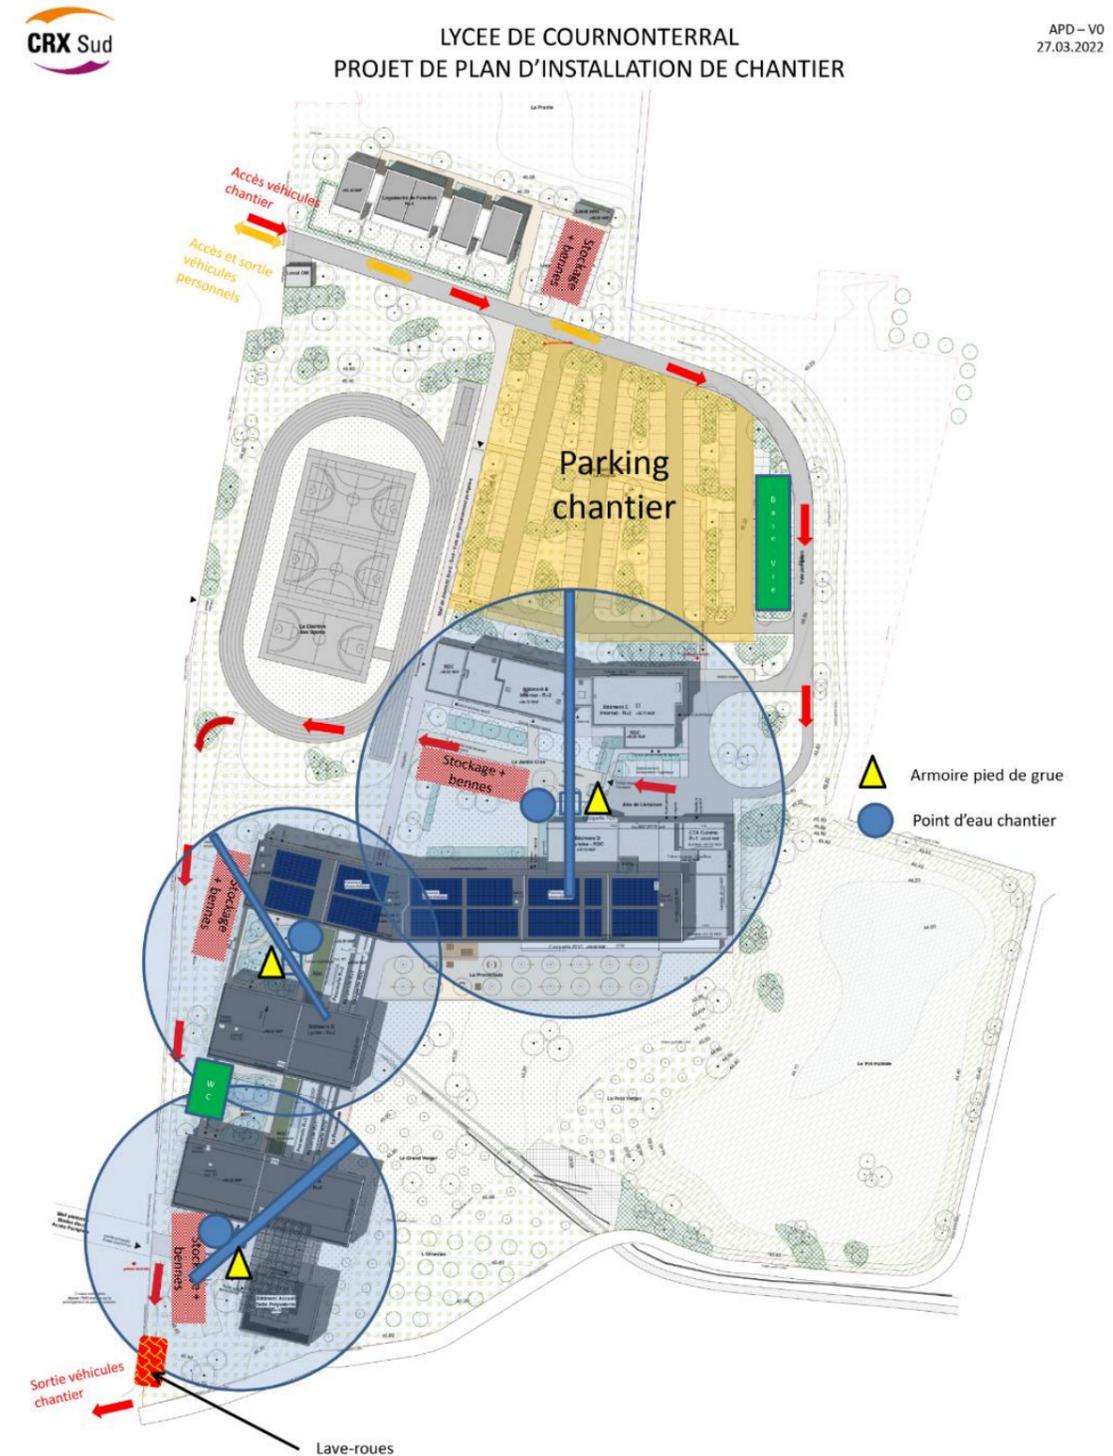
Plan d'installation de chantier (Source : APD projet Lycée Courmonterral, BPA avril 2022)
